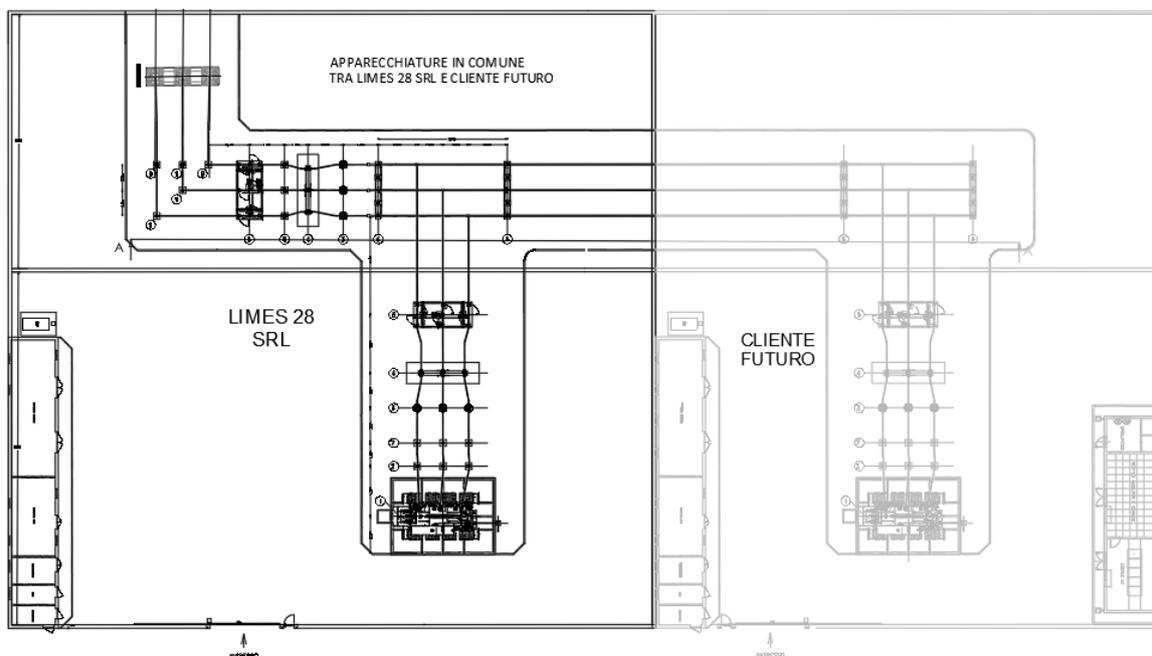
Planimetria Sottostazione Utente 30/150 kV
